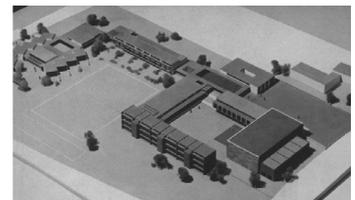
Planimetrías. Planen und Bauen im neuen Deutschland, 1959.
